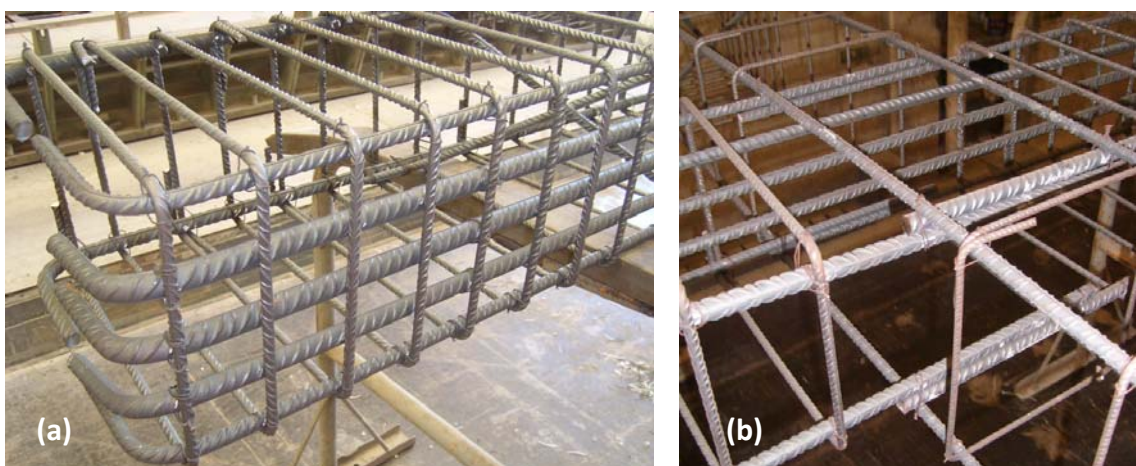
Fotografías del armado de la viga Tipo A. a) terminación en extremo, b) solape de armadura discontinua en nudo.
